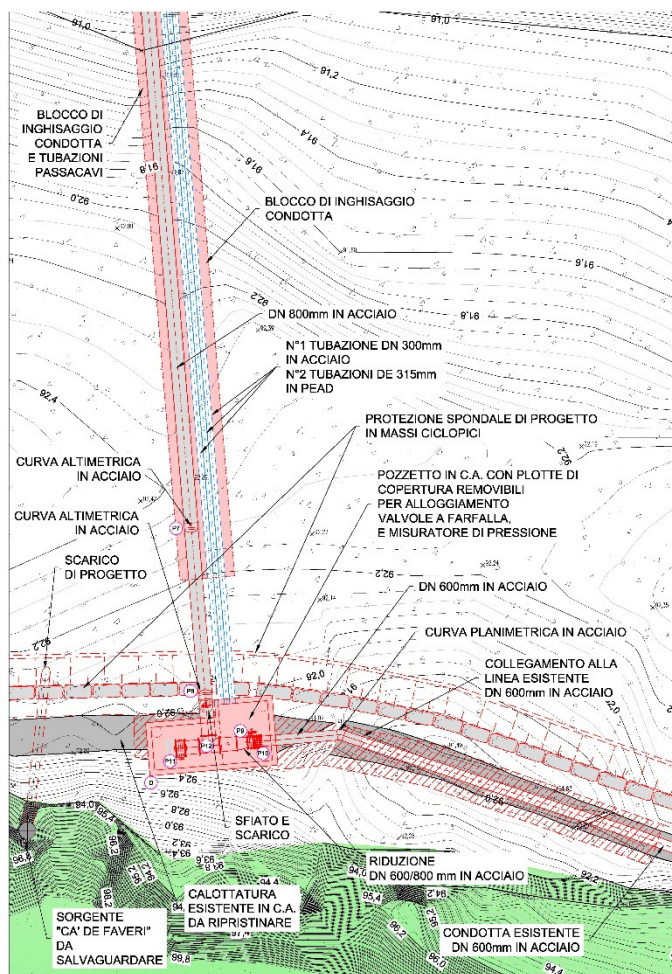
Planimetria di dettaglio del collegamento sud e sezione su camera di manovra.
